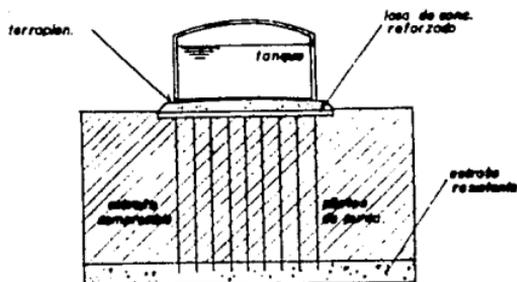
Cimentación rígida sobre pilotes de punta
